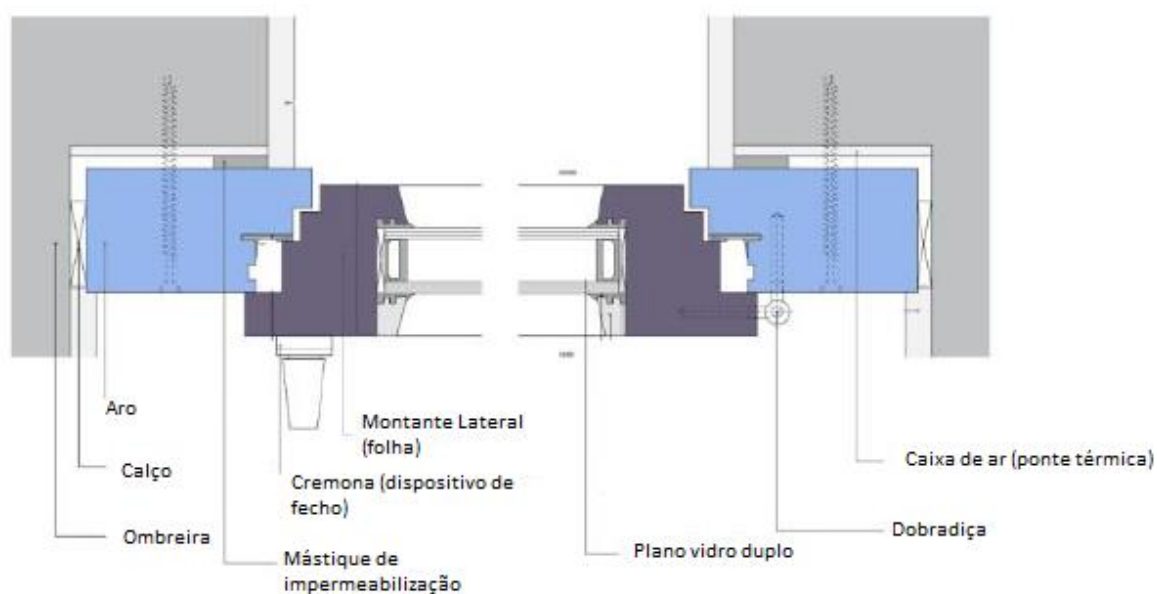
Pormenor construtivo horizontal da caixilharia
